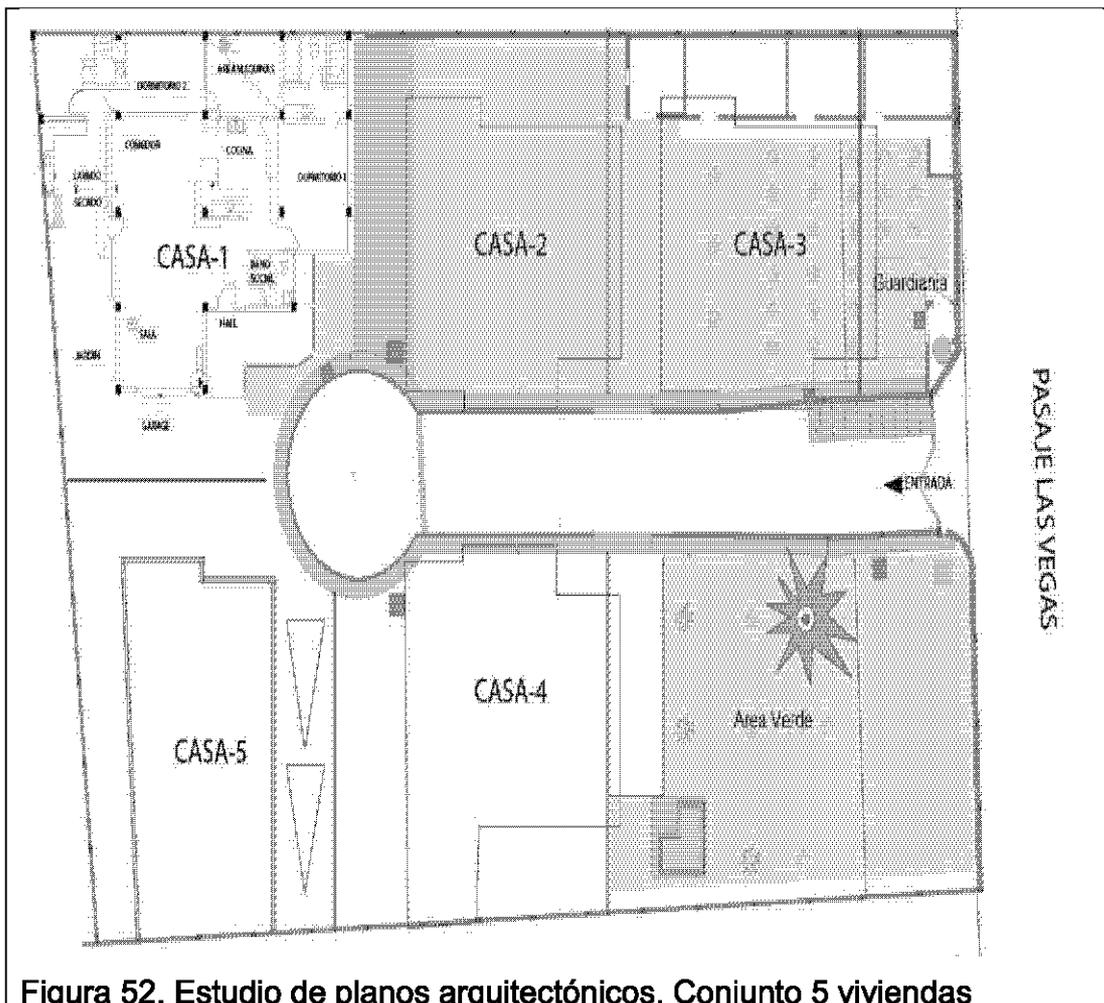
Estudio de planos arquitectónicos. Conjunto 5 viviendas
